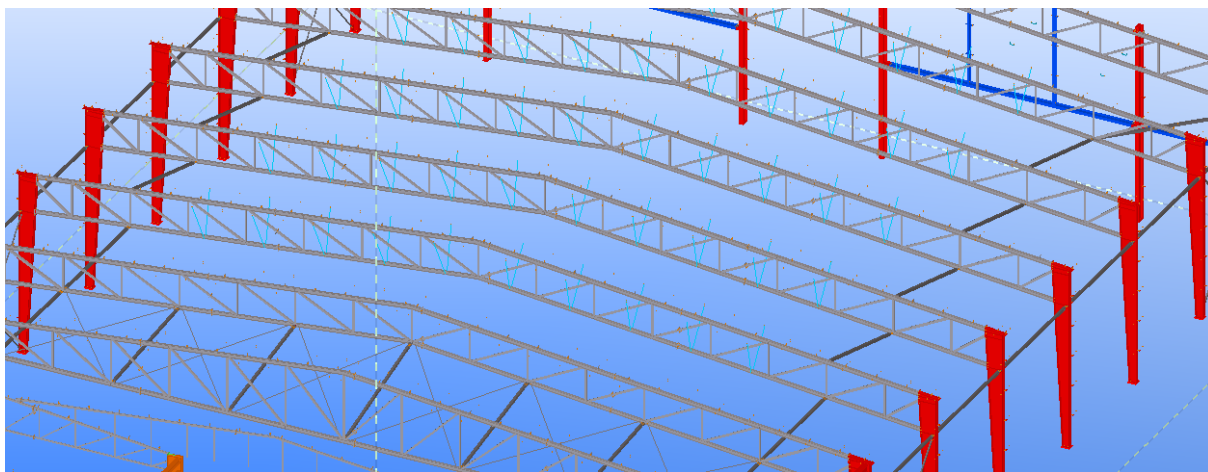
Diseño de pórtico con pilares en viga armada y dintel en celosía
